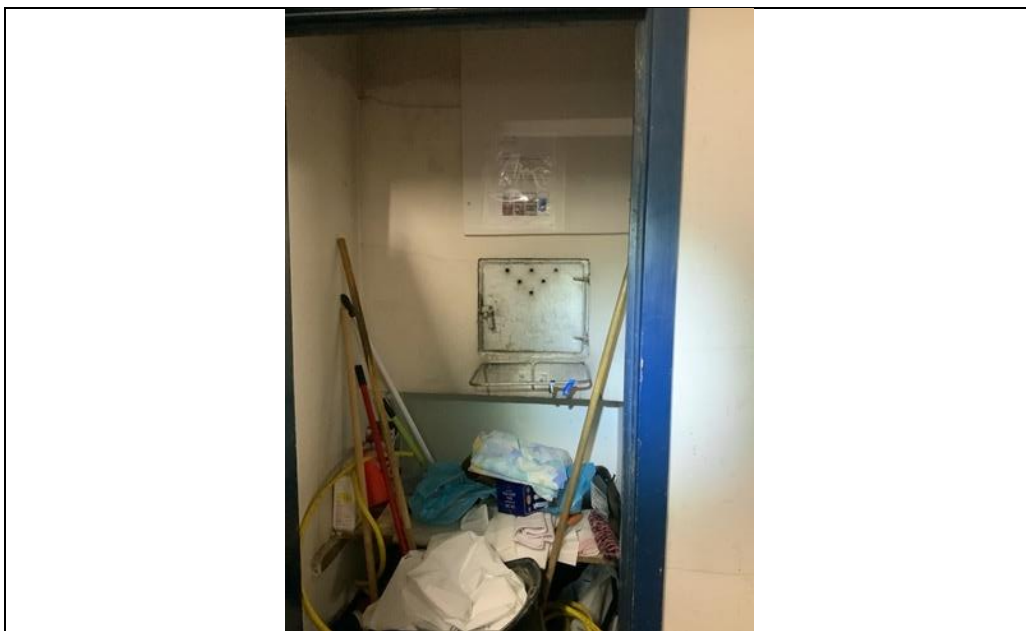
betonnen afvalkoker in ondergrondse parking op -1
